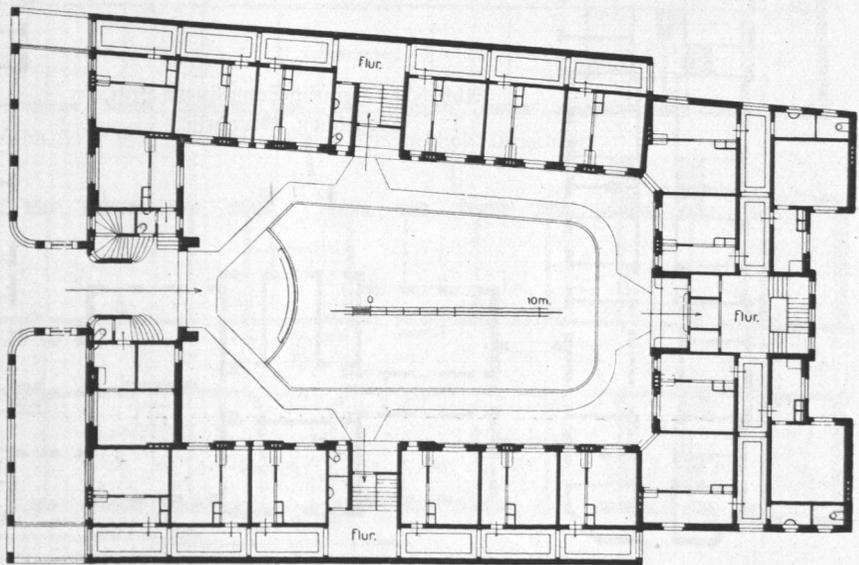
Dirick-Roster-Testaments-Wohnungen, Erdgeschoß, Grundriß.
